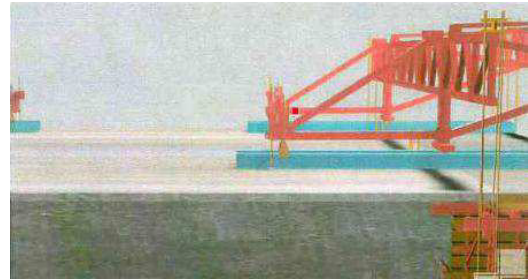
PROC – Betonagem da laje inferior [11]
